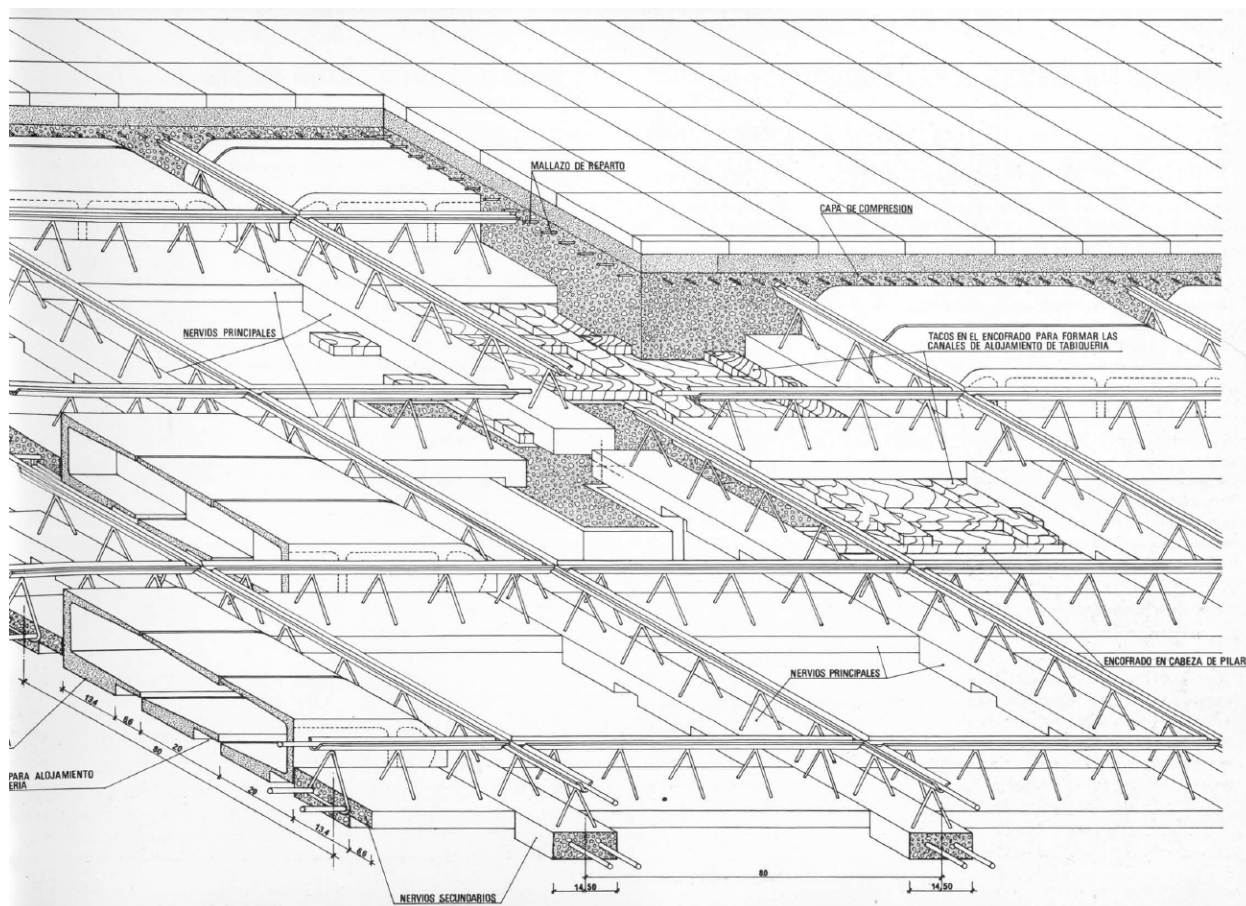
Detalle constructivo de forjado del sistema Tabibloc
